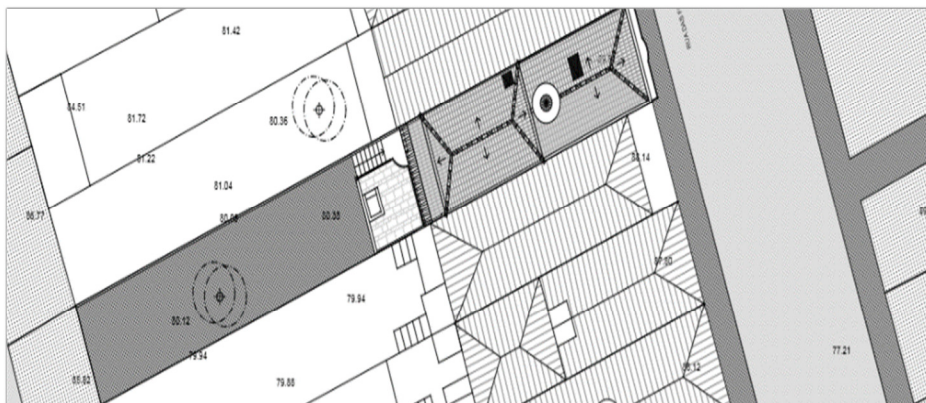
Planta de implantação do imóvel [Plano Inclinado, Lda., 2014 – Editado pelo autor].
